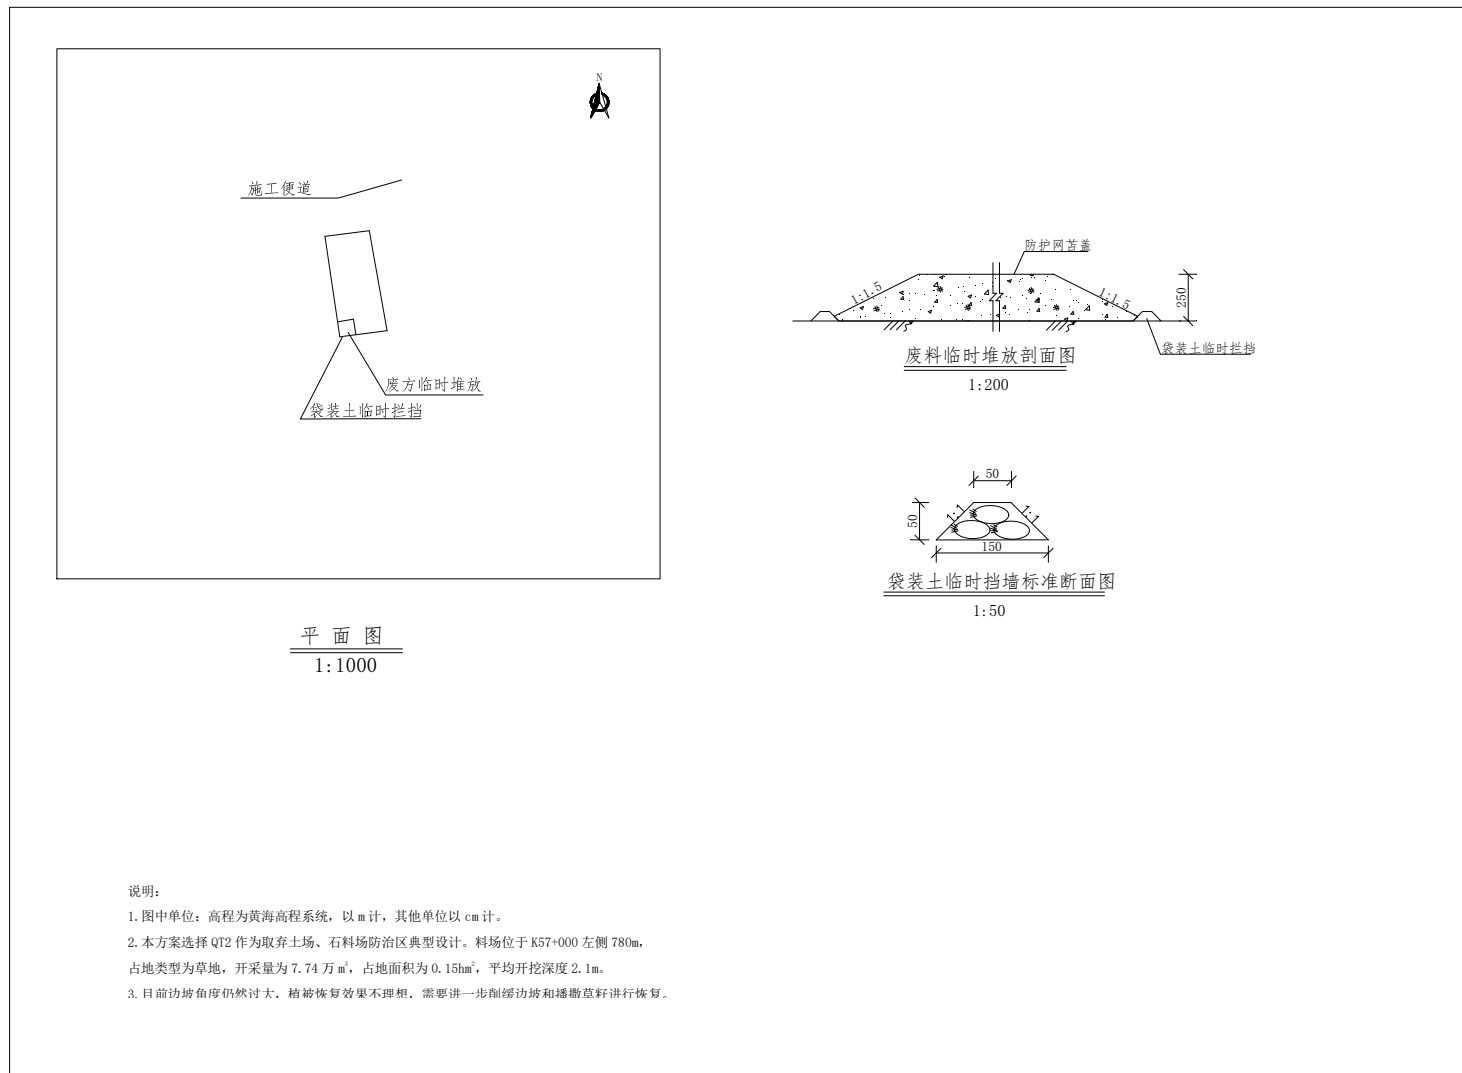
工程取、弃土场典型生态保护措施平面布置图
